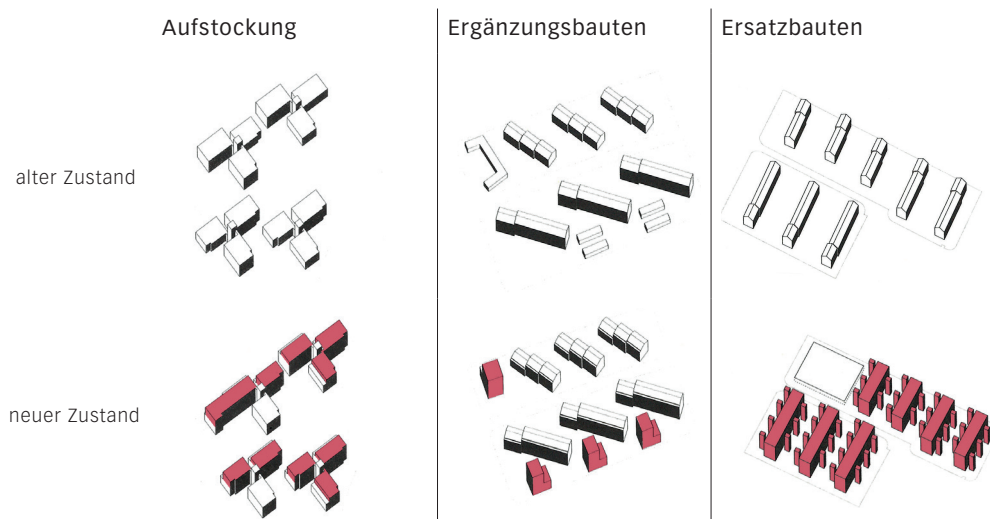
Verhaltensweisen Nachverdichtung: Aufstockung, Ergänzungsbauten, Ersatzbauten
